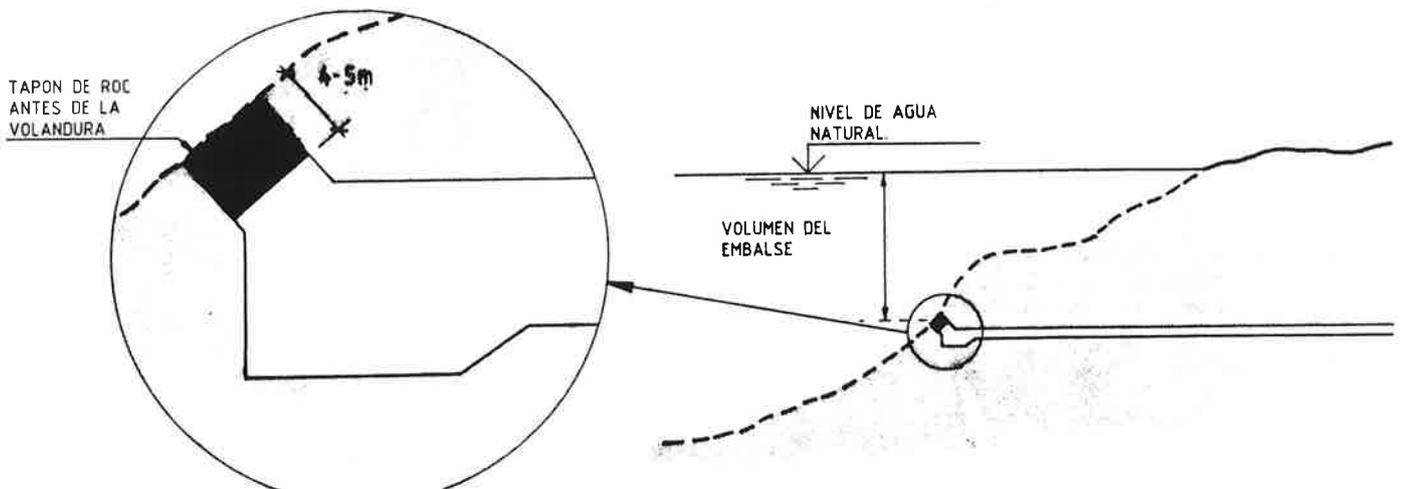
El tapón en los lagos y las perforaciones sumergidas de túneles, son una de las especialidades Noruegas en la construcción de centrales hidroeléctricas. Las perforaciones se llevan a cabo excavando un túnel en las rocas bajo el fondo del lago, hasta un punto preseleccionado, desde donde ambas partes se unen al volar el tapón. De esta manera el lago se hace accesible para la explotación hidroeléctrica utilizando el volumen de almacenamiento dispa por debajo del nivel original del agua.
